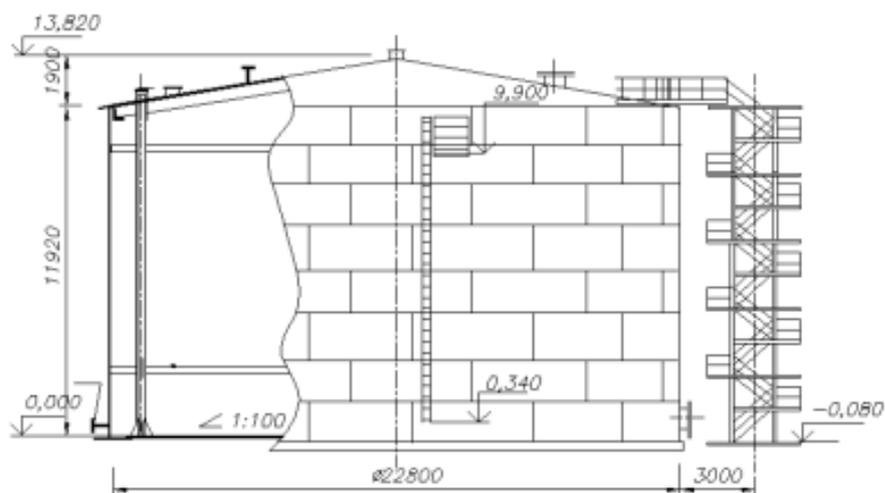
Расчётно-конструктивный чертеж резервуара 5000 м³
